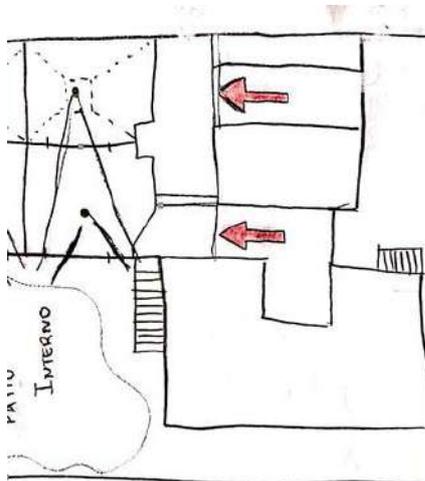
Croqui Esquemático da Fachada da Escola de Belo Horizonte.
